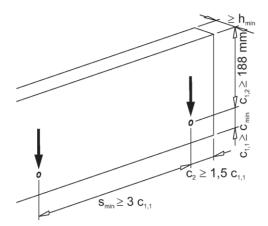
Einbausituation Wandfläche - Querbeanspruchung mit Betonkantenbruch, ohne Rückhängebewehrung
